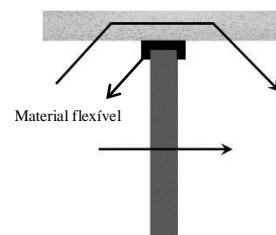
Utilização de material flexível na ligação parede-teto ou parede-pavimento
